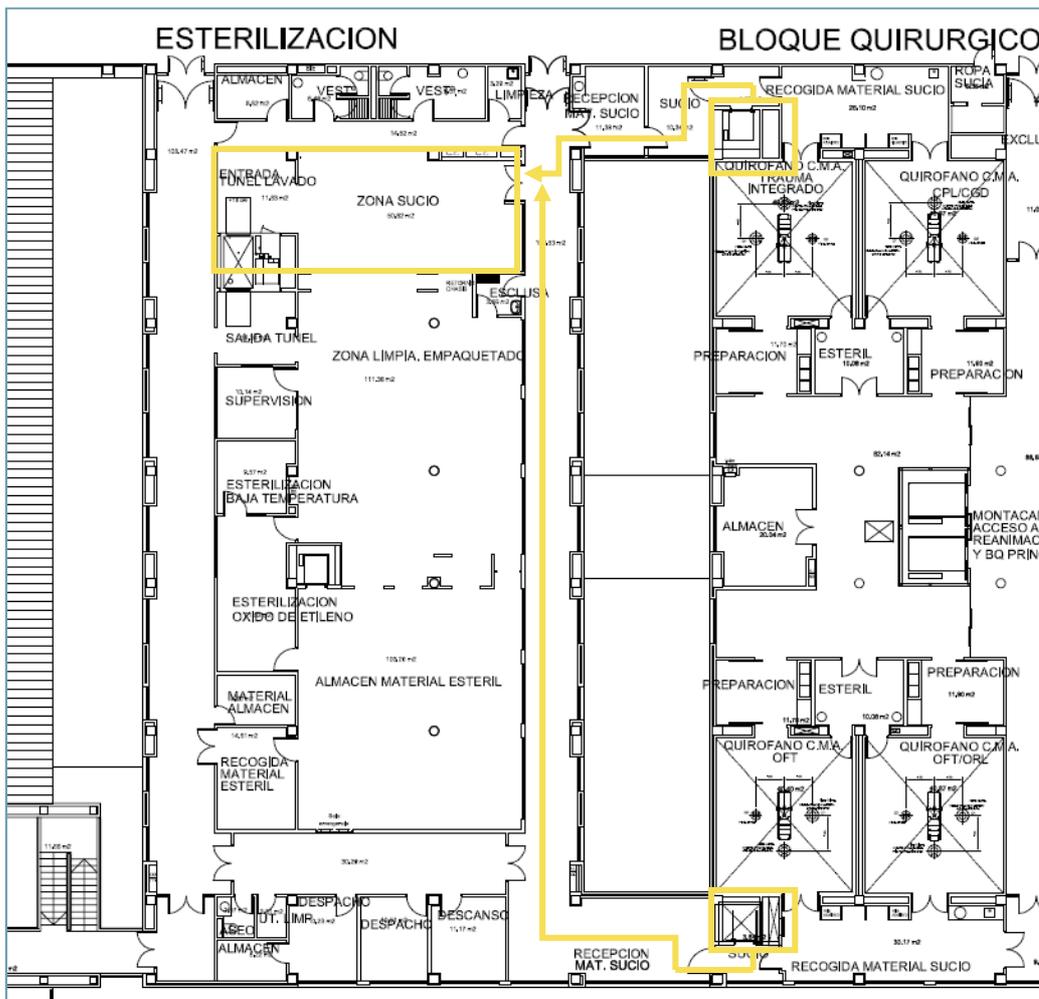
Plano esquemático de la zona sucio del servicio de esterilización.
